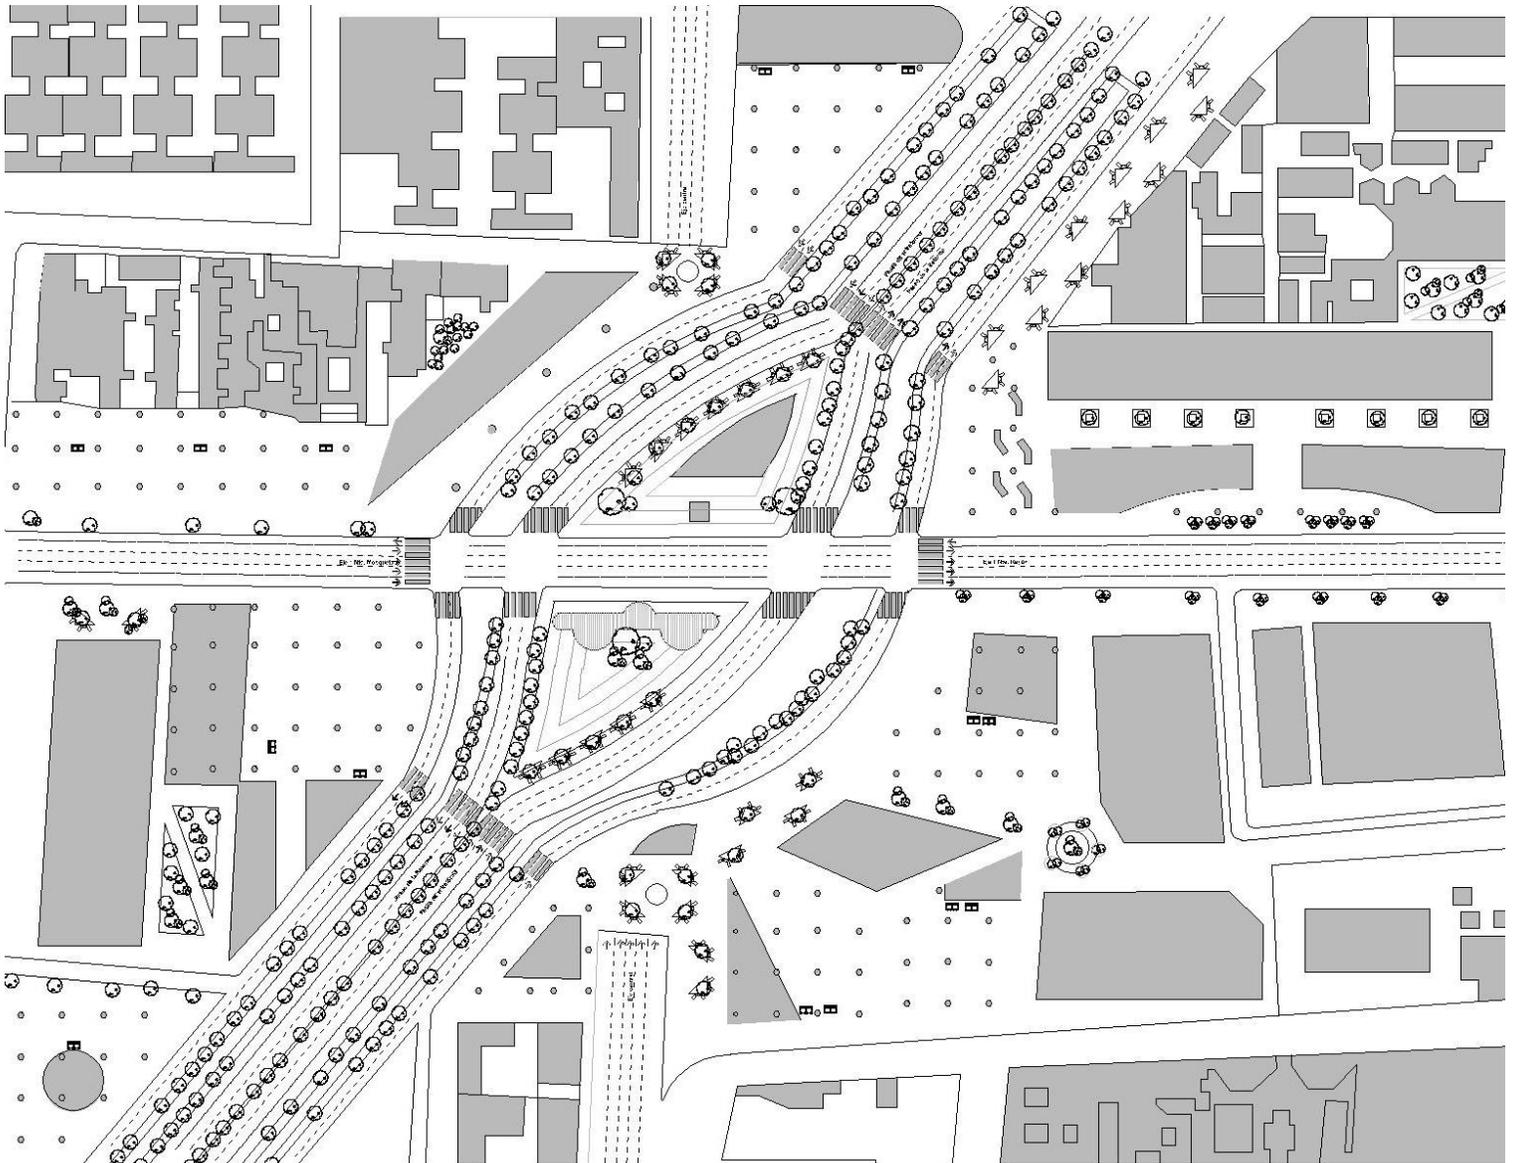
Plano en planta baja arquitectónica de nodo de intervención. Elaboración propia.
